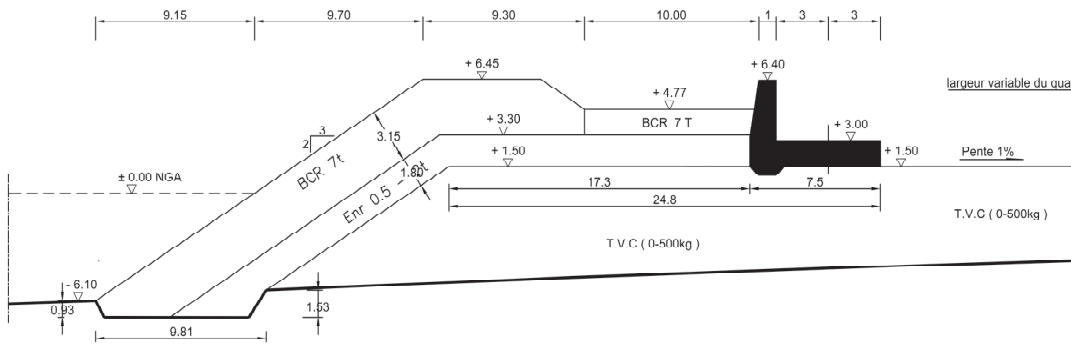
Coupe transversale 2 du profil enracinement de la jetée principale
